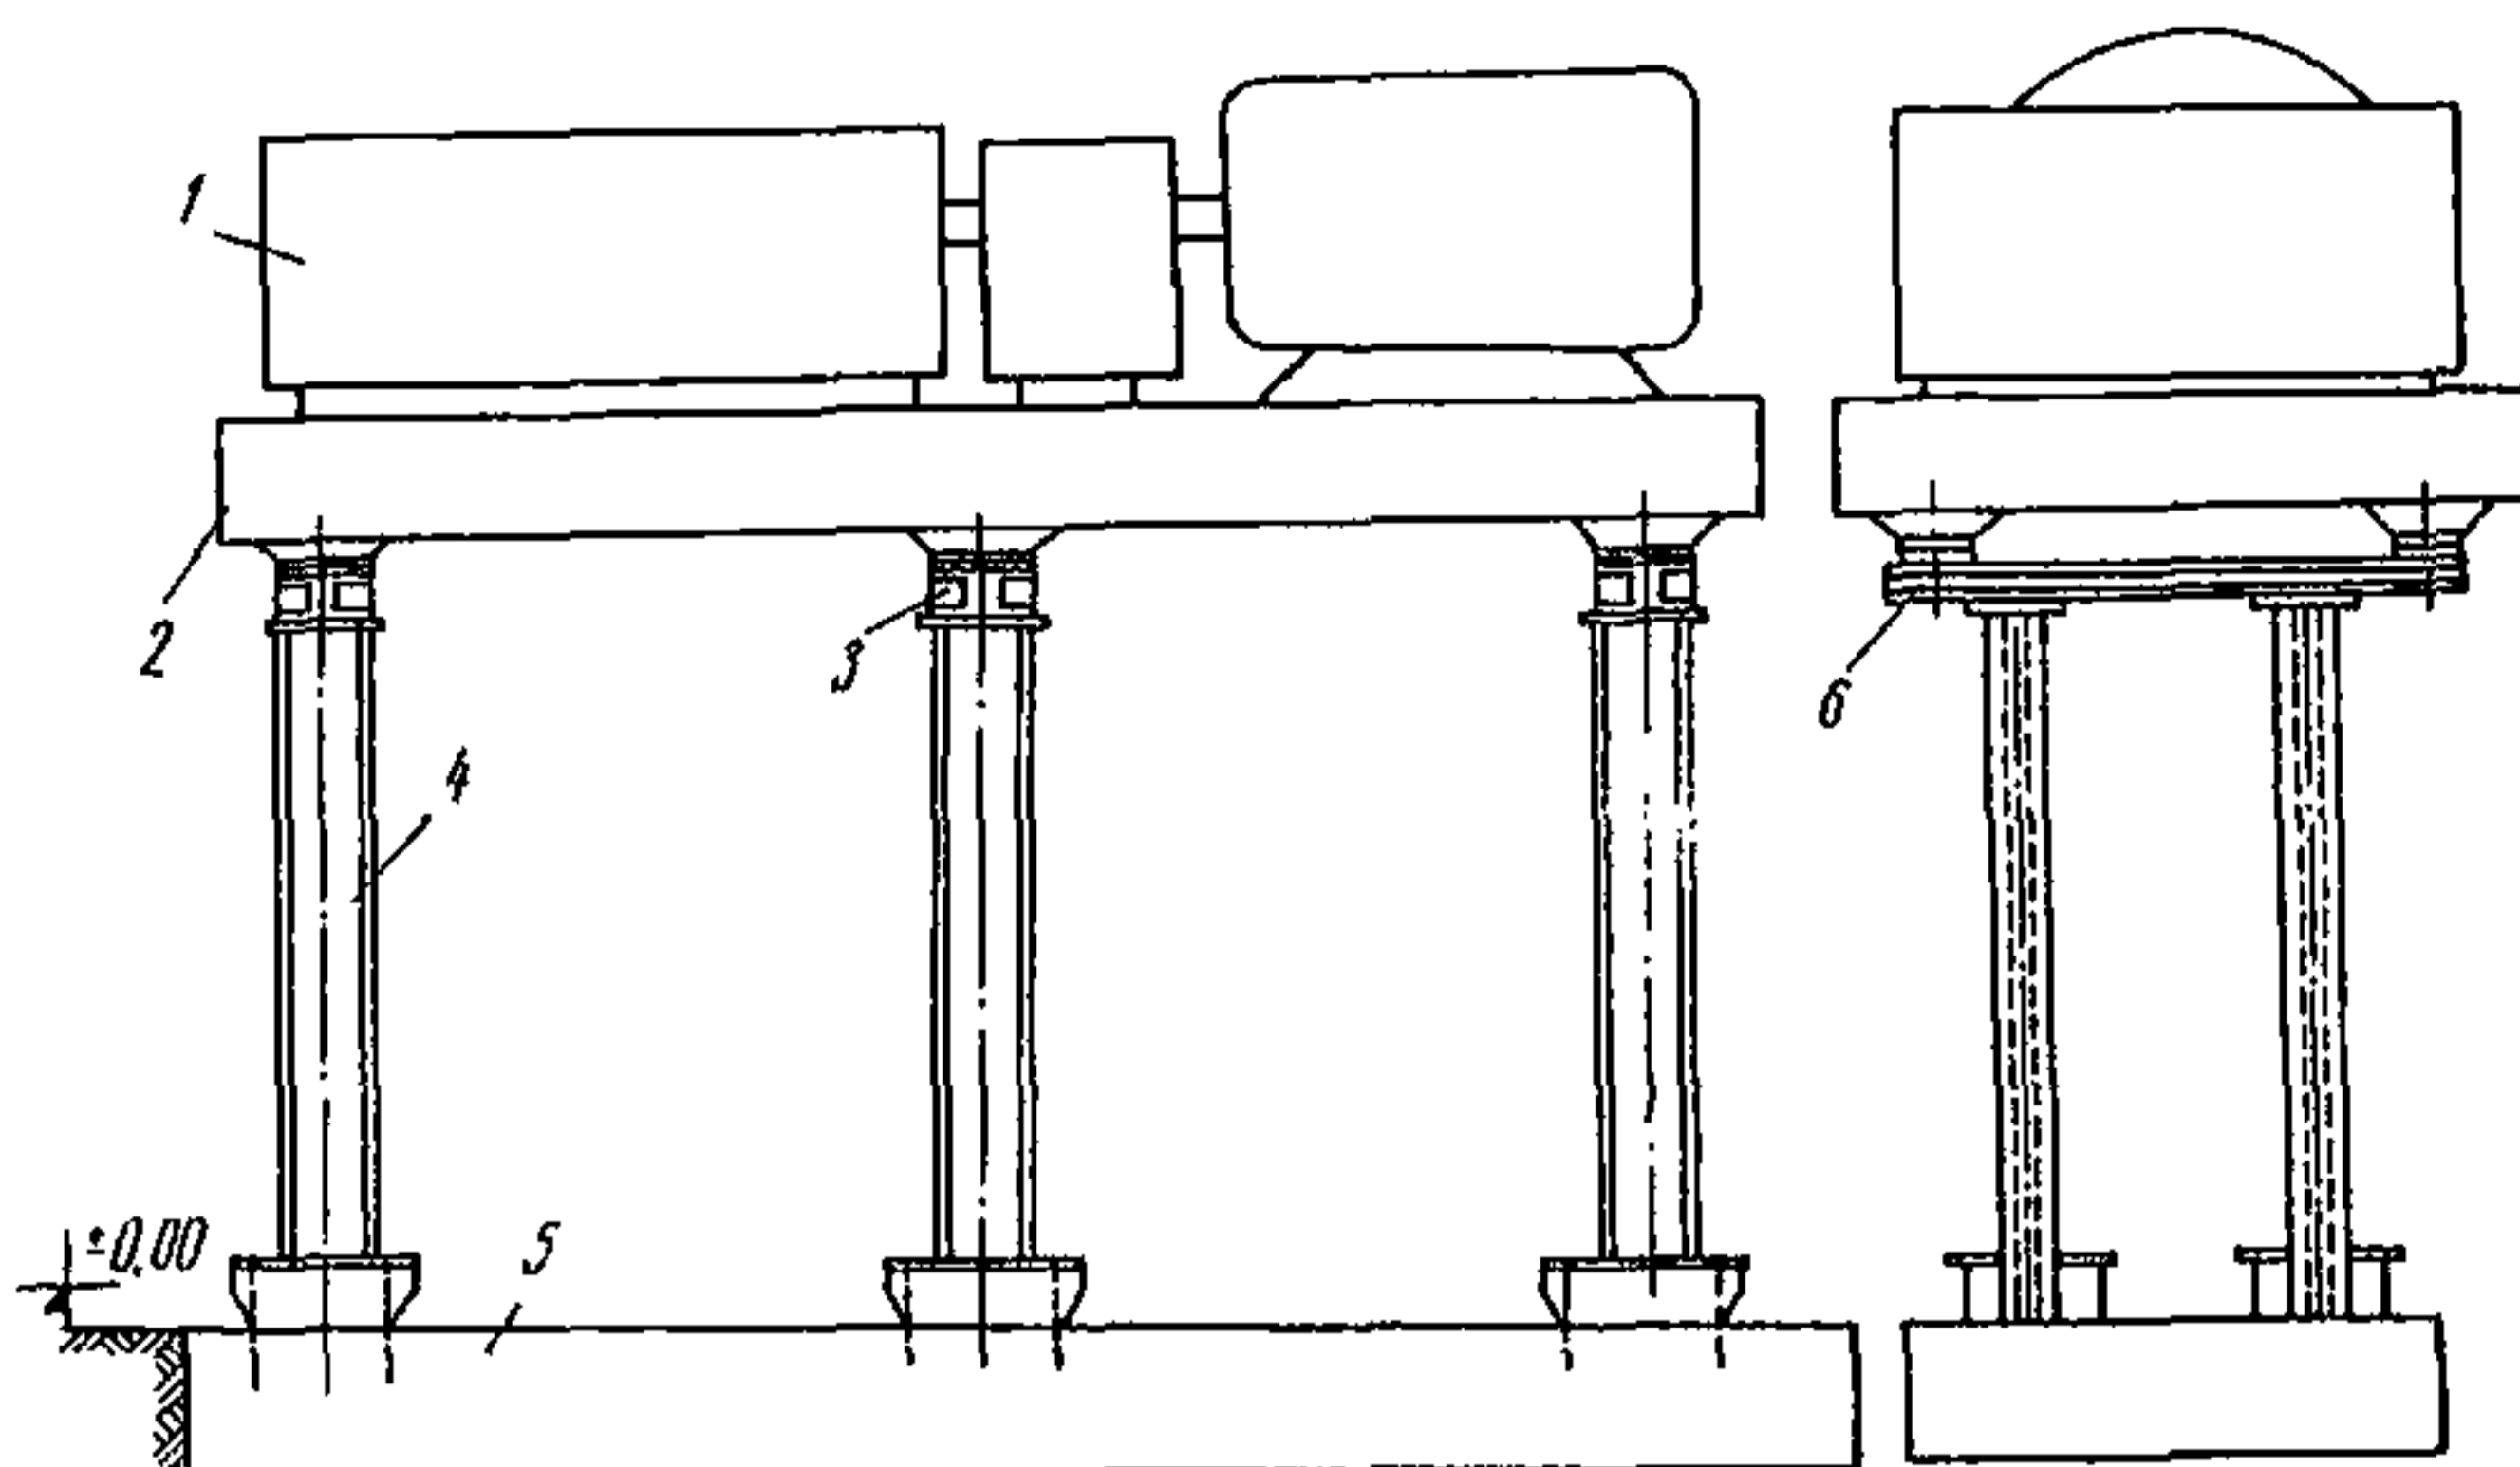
Схема рамного фундамента из металлических поперечных рам с гибкими консольными элементами
